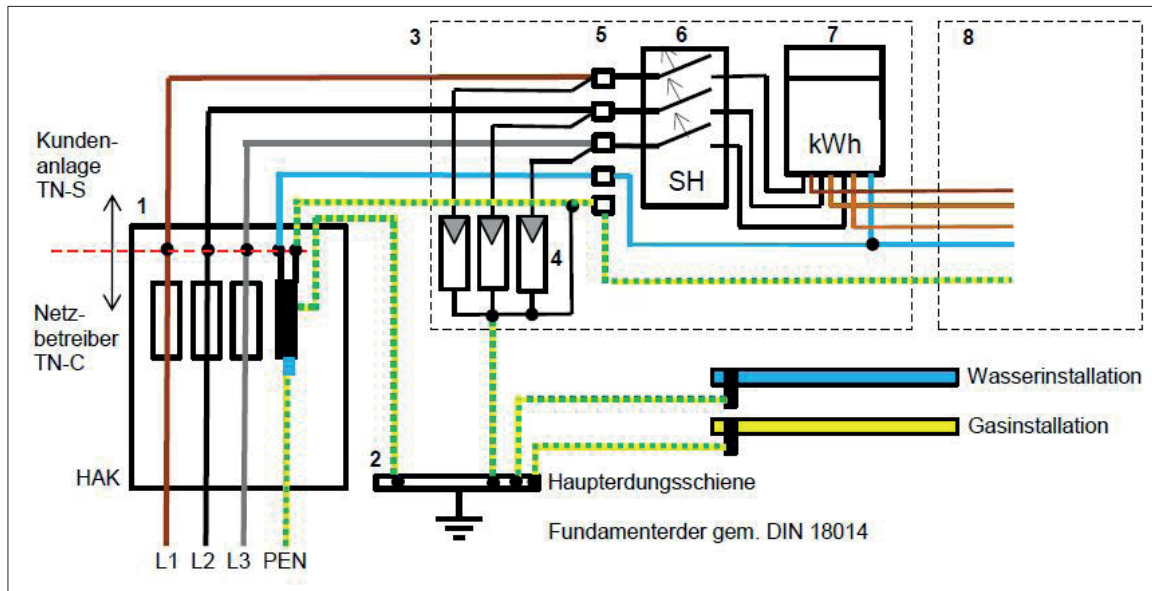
Kundenanlage mit TN-S-System (5-adrige Hauptleitung NYM-J ab HAK)
